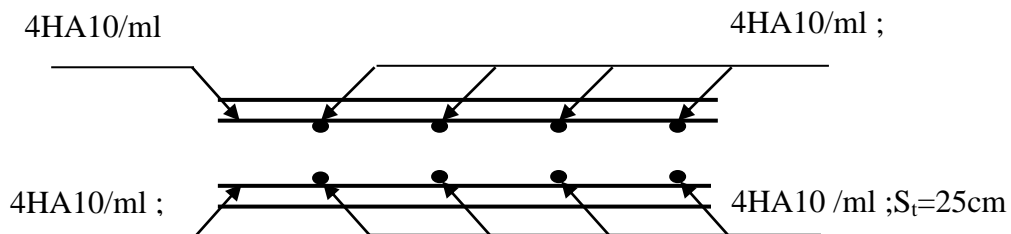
Vue en coupe du ferrailage de la dalle.
